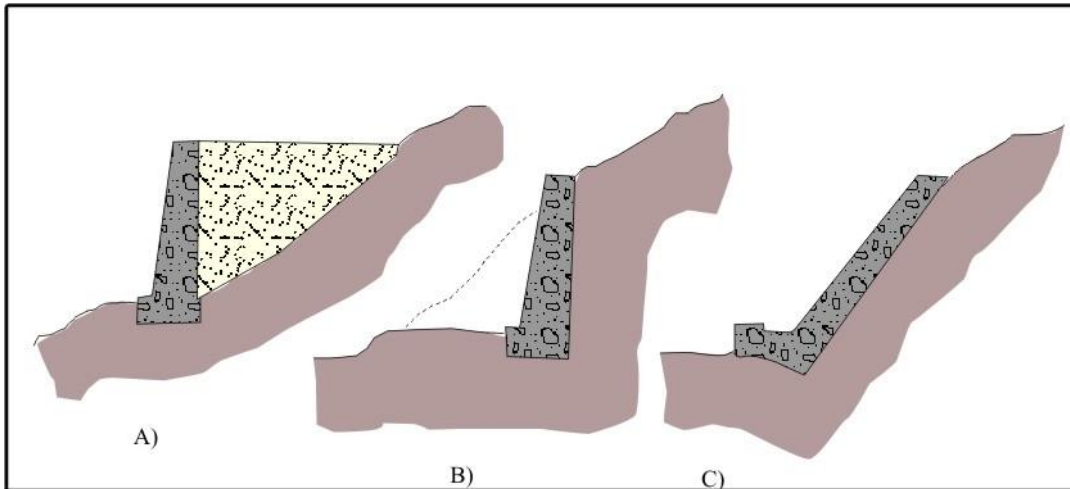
a) Muro de sostenimiento b) Muro de contención c) Muro de revestimiento.
